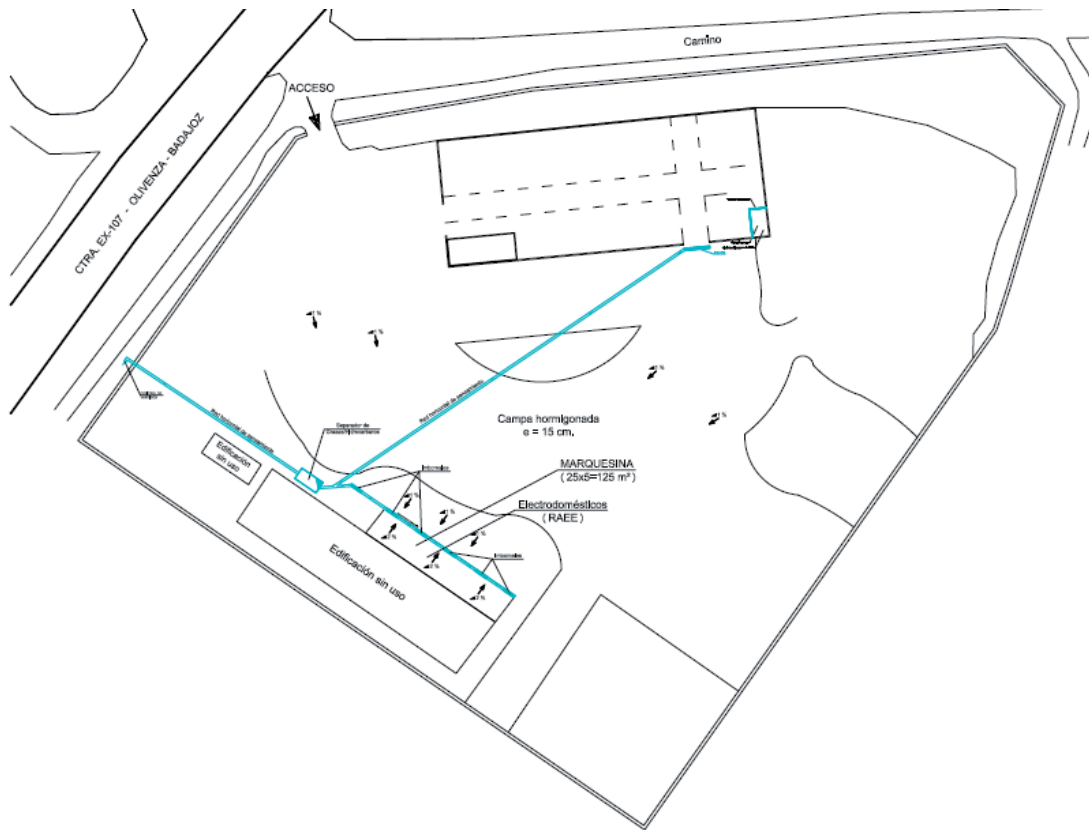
Plano en planta de las instalaciones. Redes de saneamiento
